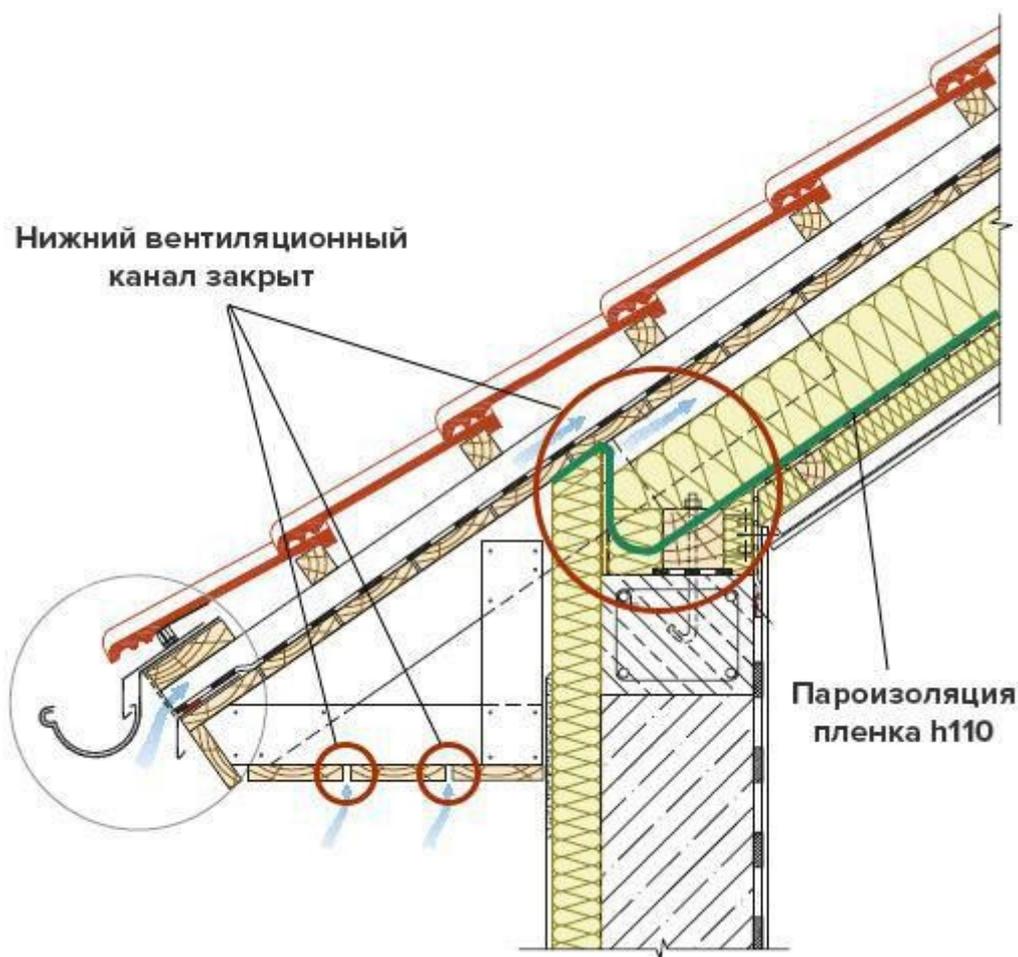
Места перекрытия нижнего вентиляционного канала и предполагаемое расположение пароизоляции Н 110 в узле примыкания кровли к ограждающим конструкциям стены.
